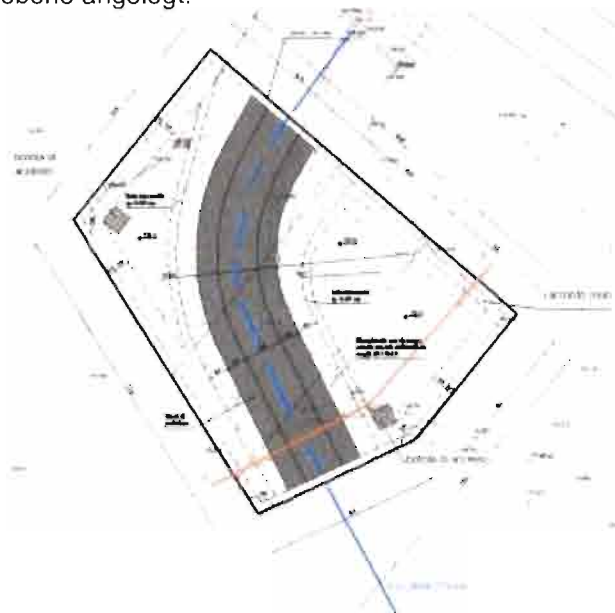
Lageplan des geplanten Unterführungskanals
